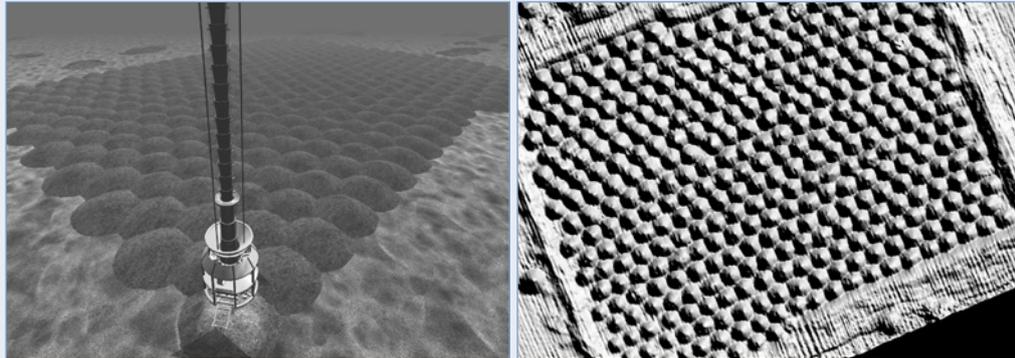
Exemple de fondation en mer construite par un navire équipé d'un tube plongeur flexible (source : Van Oord)
